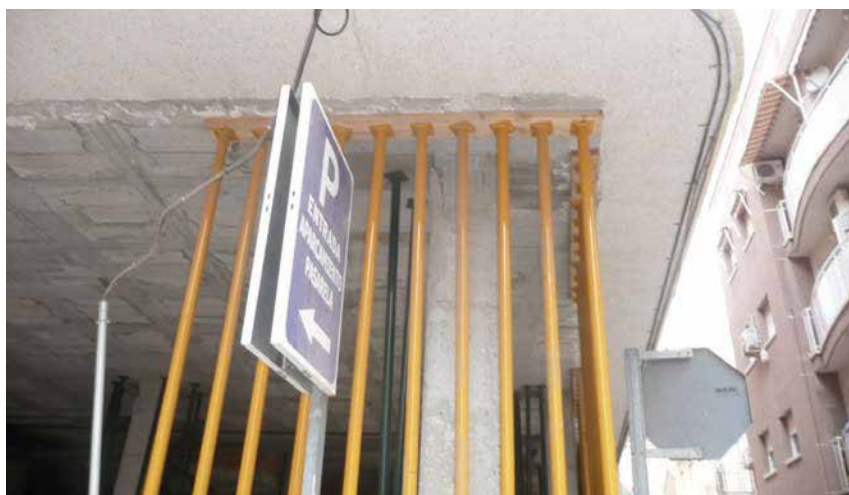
Diseño de apeo de pilar. Situado en la Calle Turbintos de Lorca.
